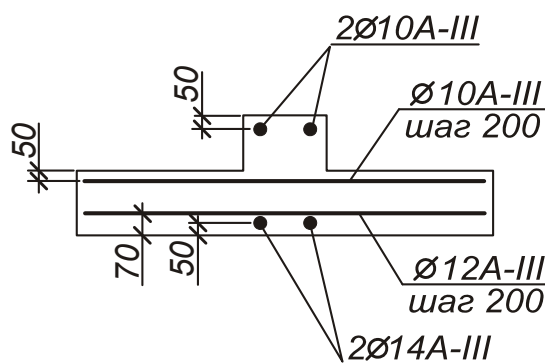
Схема расположения рабочей арматуры в фундаментной панели
